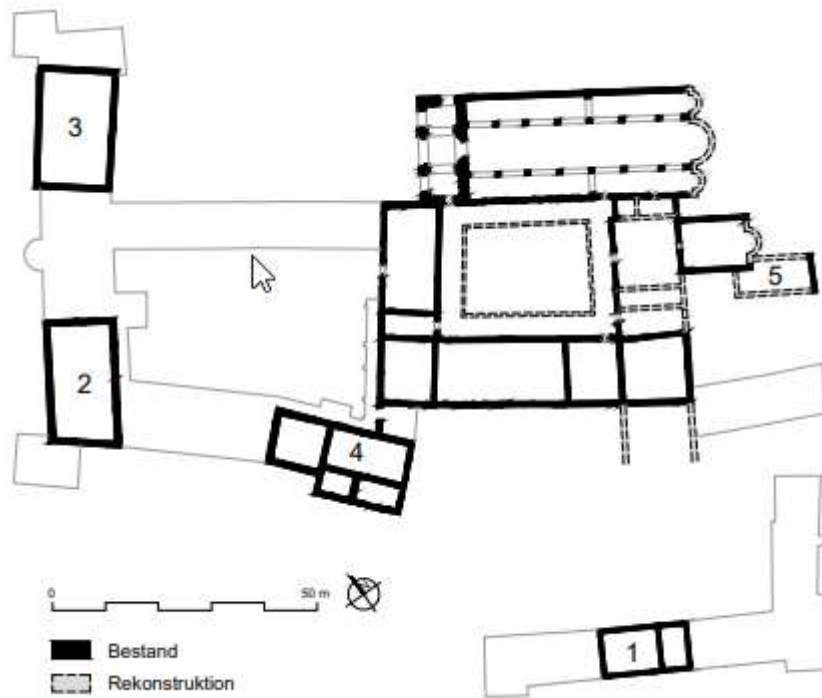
Schematischer Grundriss der Klosteranlage mit dem Klostergeviert und den umstehend erhaltenen Klostergebäuden. (© Wolfgang, Plangrundlage: EKG Baukultur, Wien)
